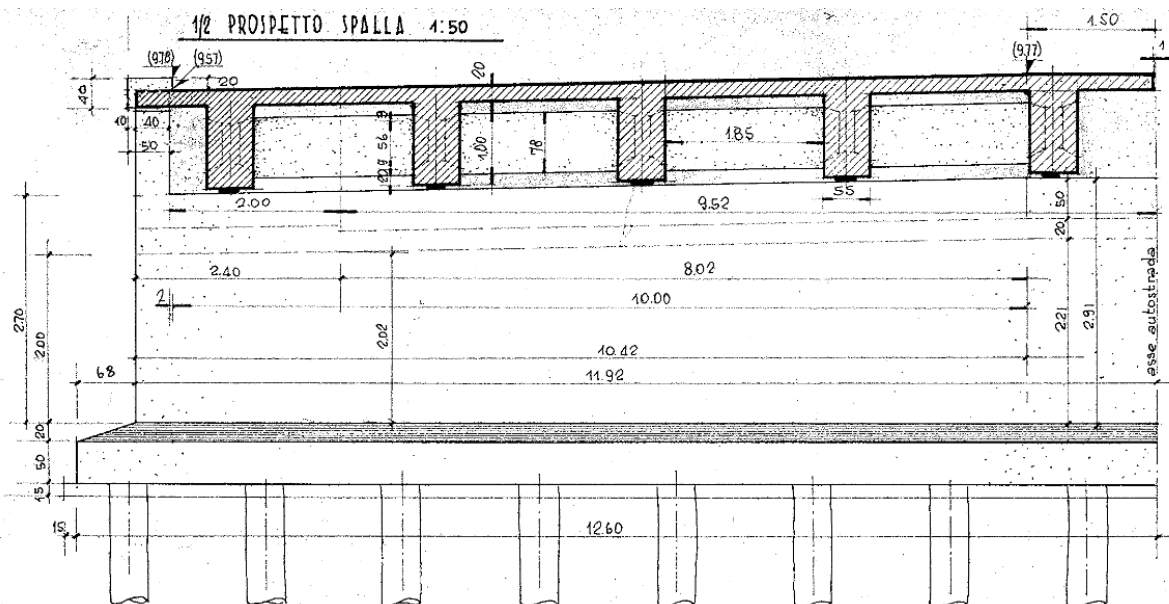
1/2 Prospetto spalla esistente
